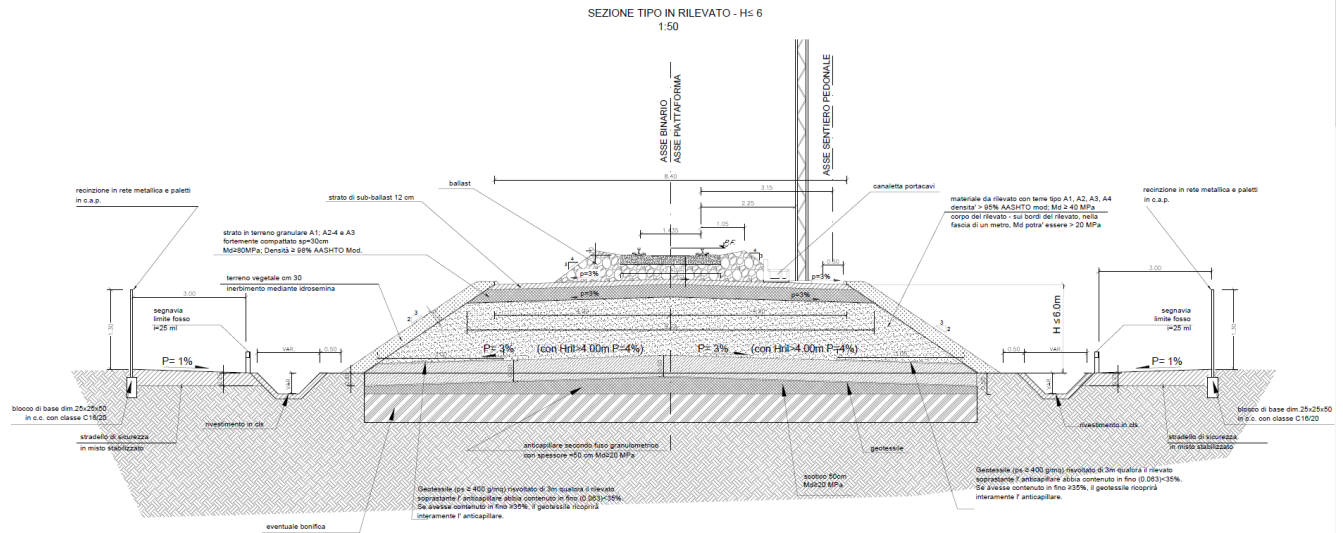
Sezione tipo in rilevato a SB, H ≤ 6.0 m
